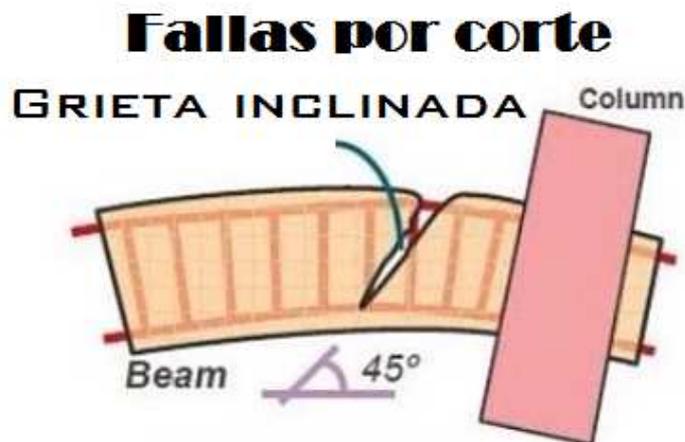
Fallas típicas en vigas de hormigón armado (Jonzalez, 2011)
